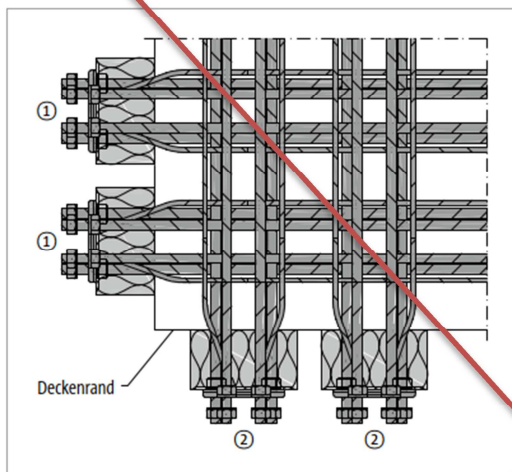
Schöck Isokorb® XT Typ SK: Außenecke
